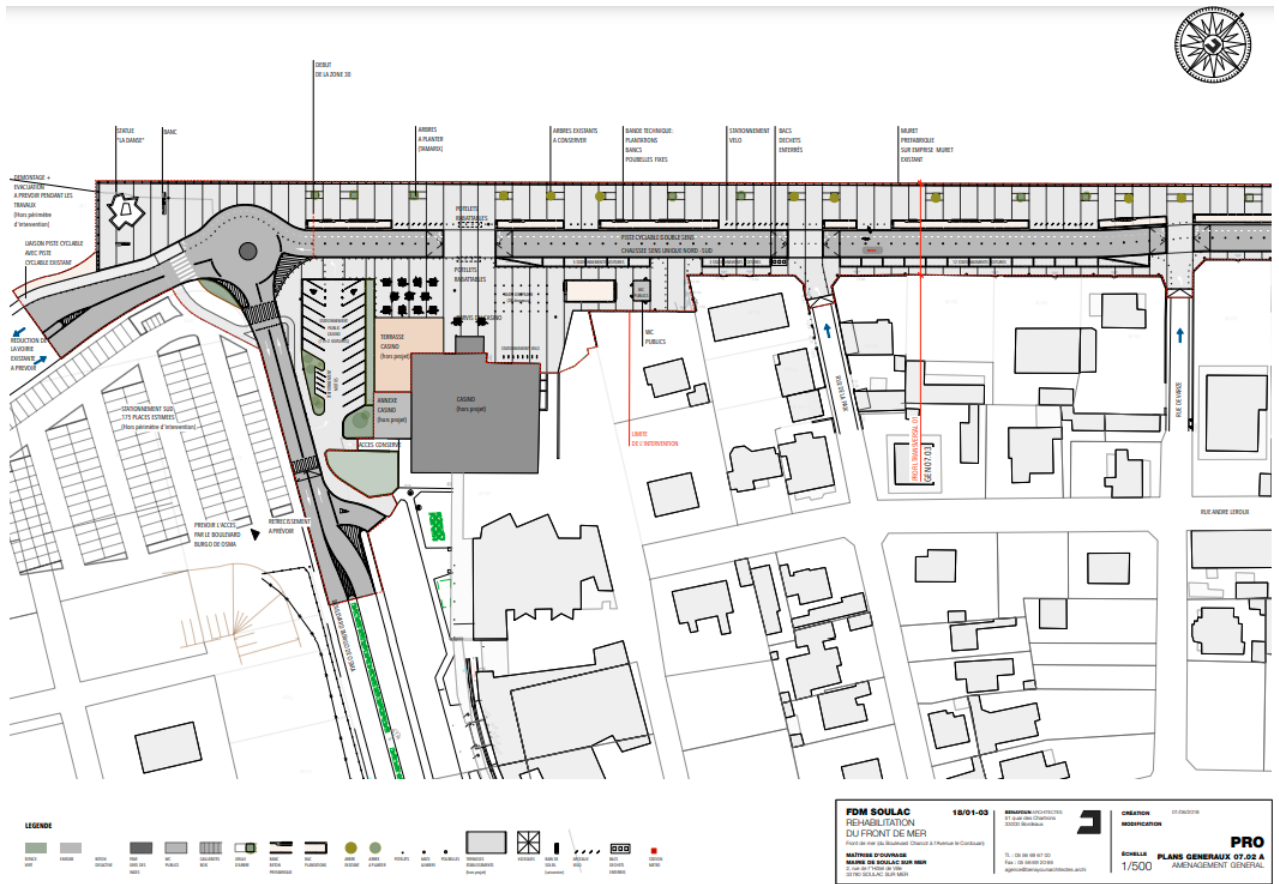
Plans de l'aménagement projeté (portion 1) (Source : PRO –juin 2018)
